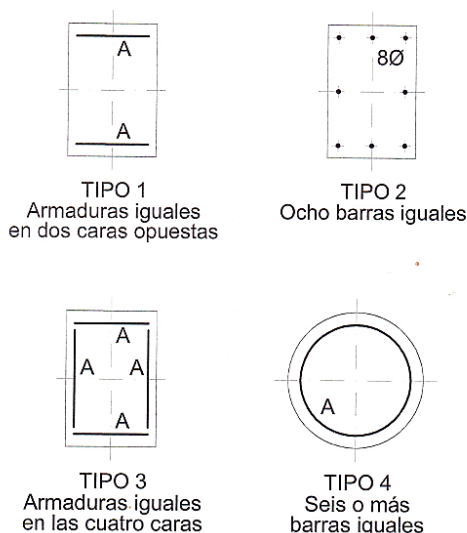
Tipos de armado para soporte (fuente: Jiménez Montoya, 2009)
